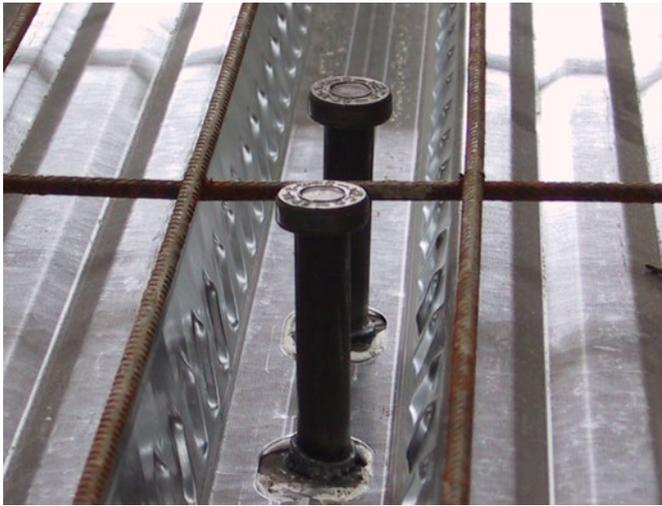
Treillis d'armatures, goujons soudés et bac prépercé avant le coulage du béton
